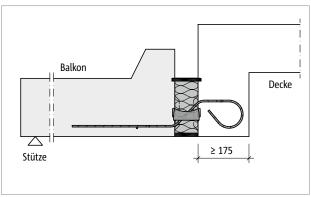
Schöck Isokorb® T Typ QL: Einbausituation «Balkonplatte als Ele-
